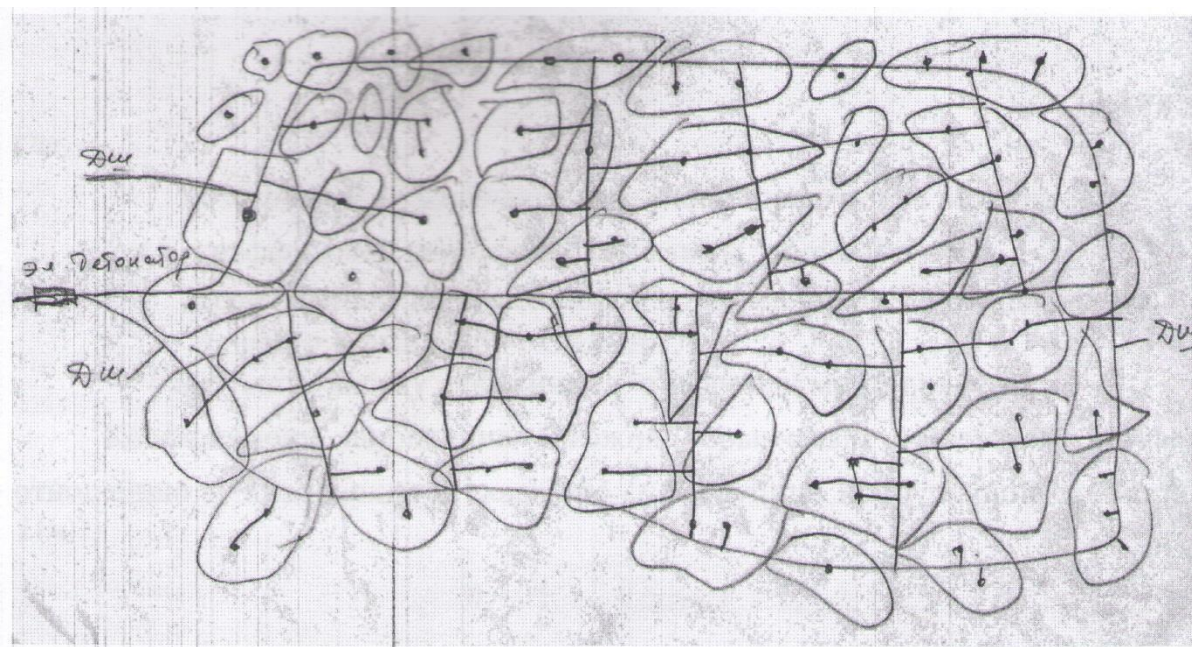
Схема соединения детонирующего шнура и конструкция заряда
